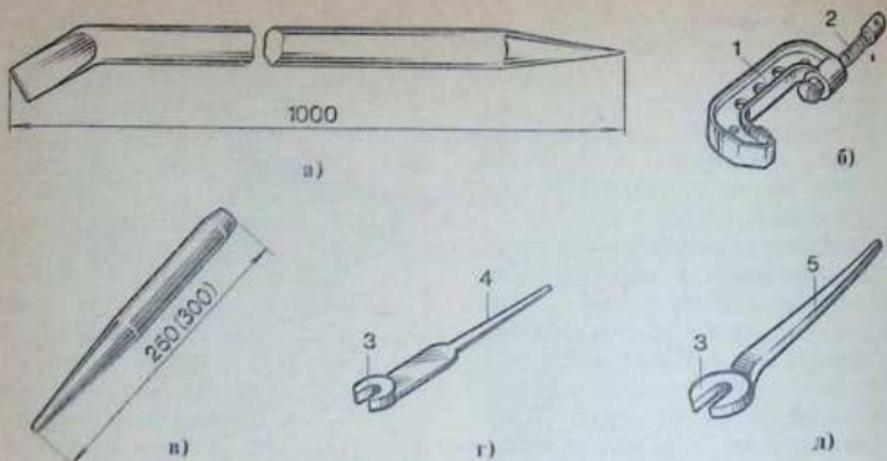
Инструменты для сборки и монтажа металлических конструкций: а — лоник, б — струбцина, в — оправка, г, д — ключи прямой и с изогнутой ручкой; 1 — скоба, 2 — винт, 3 — головка, 4 — колик, 5 — ручка
